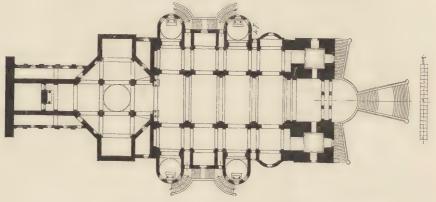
Dom zu Kempten. Grundriss.
